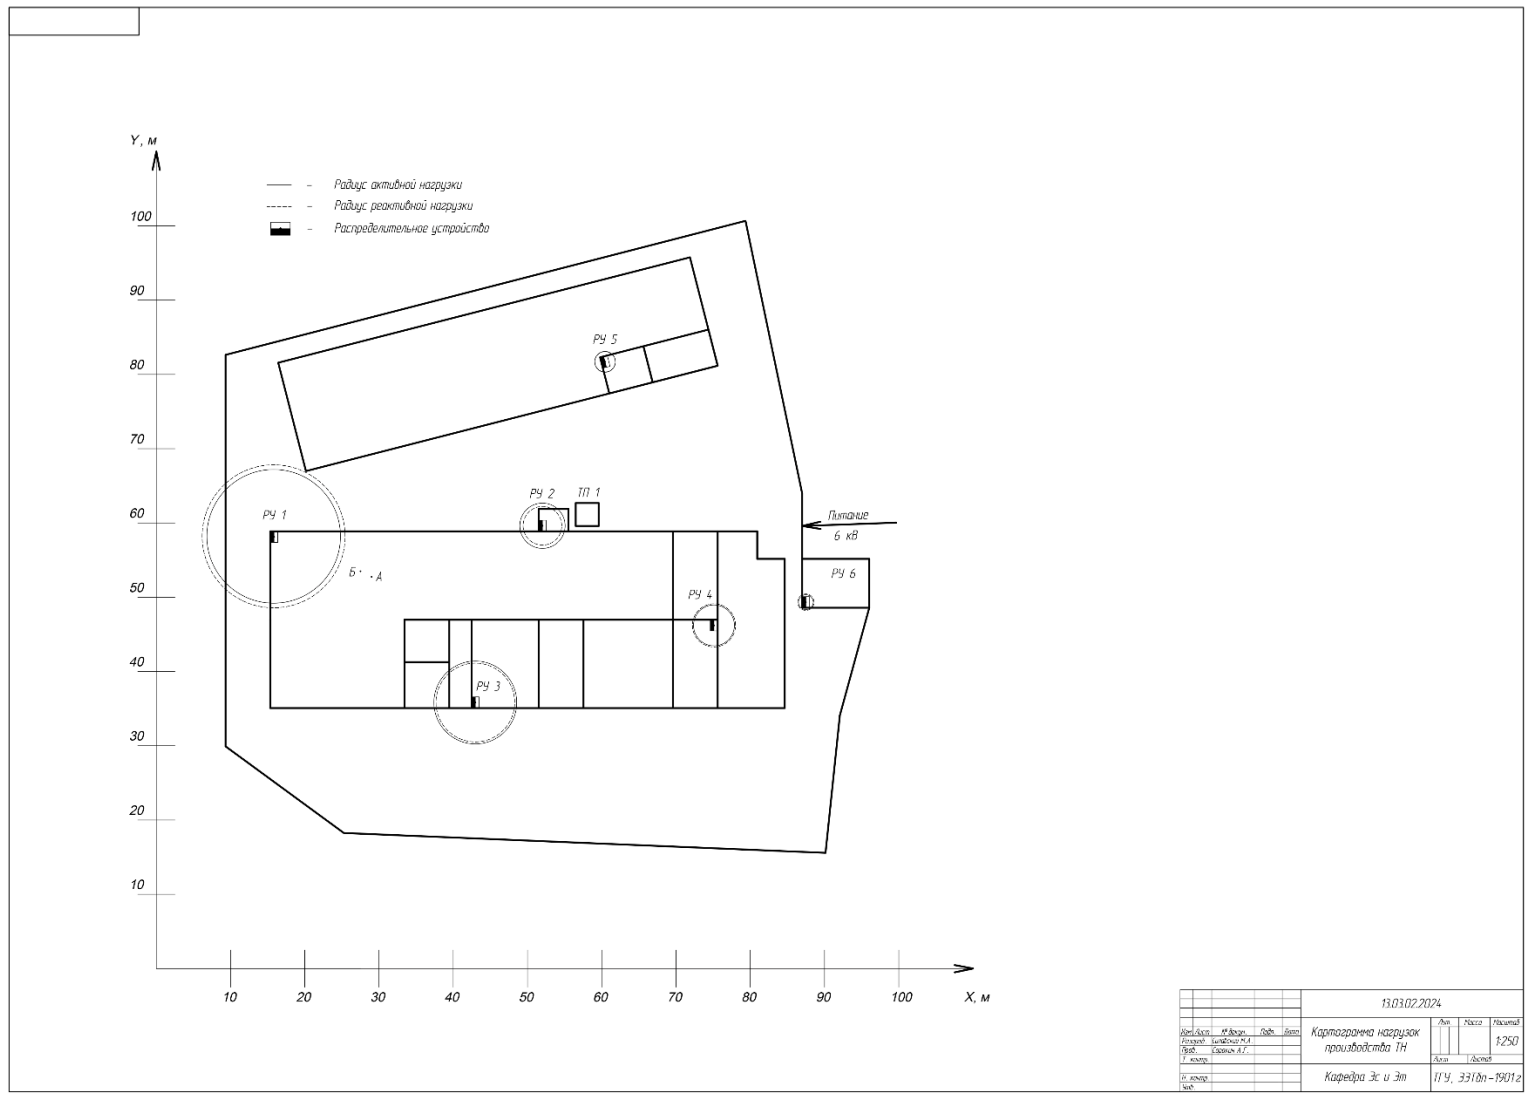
Генеральный план электроснабжения производства ТН.
